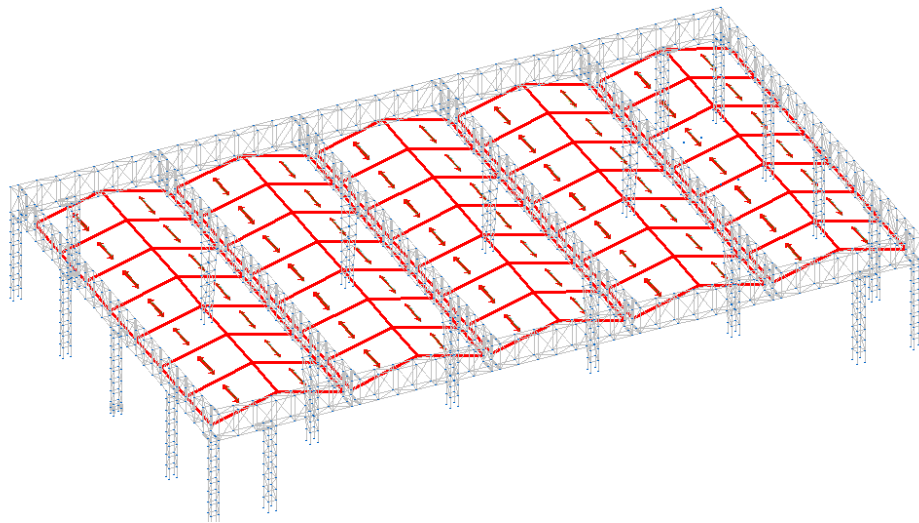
| Detalle de aplicación de sobrecargas de mantenimiento de cubierta
